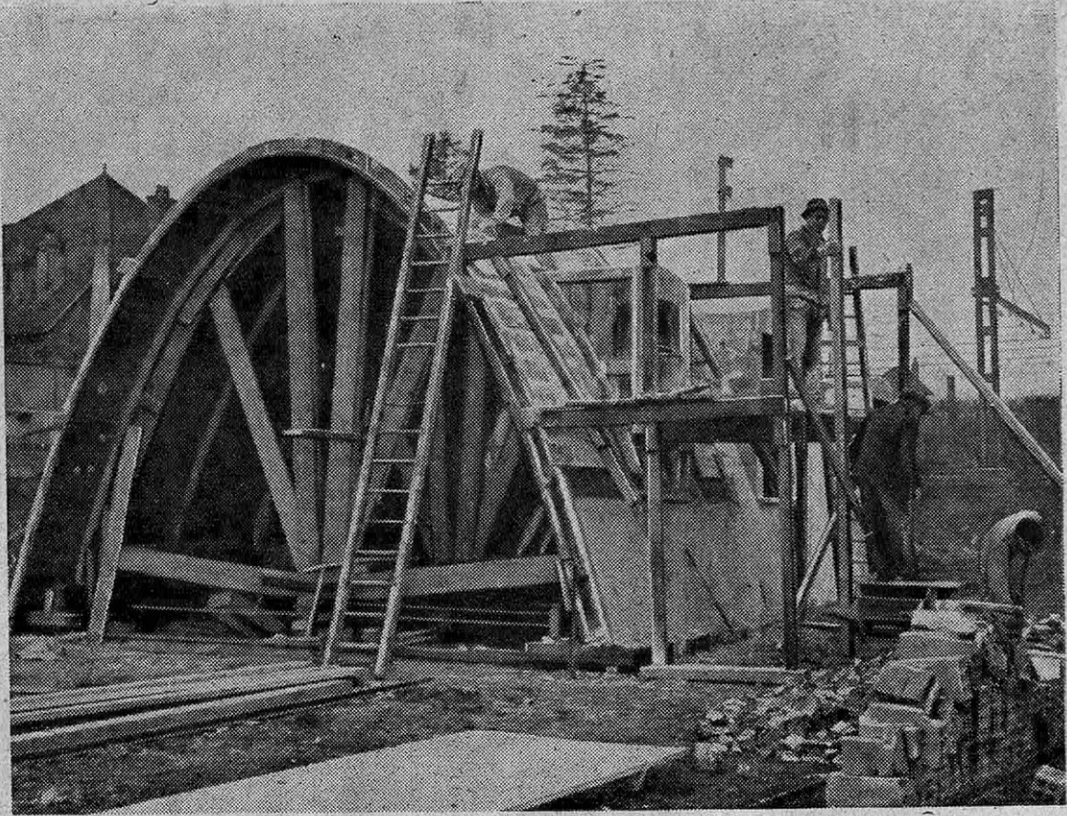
LA CONSTRUCTION D'UNE MAISON EN BÉTON DE PLÂTRE
